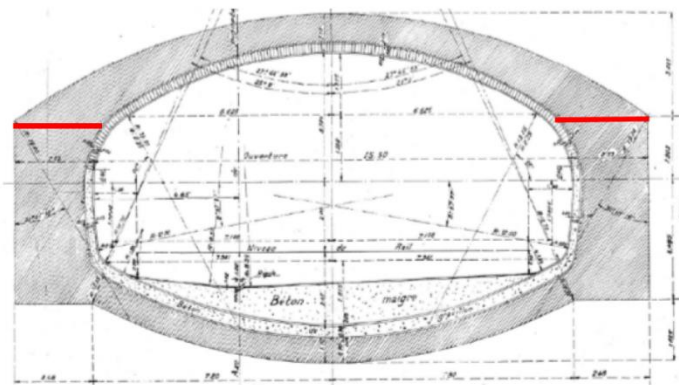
Coupe du tunnel (largeur 20.56m ; hauteur :9.97m)
